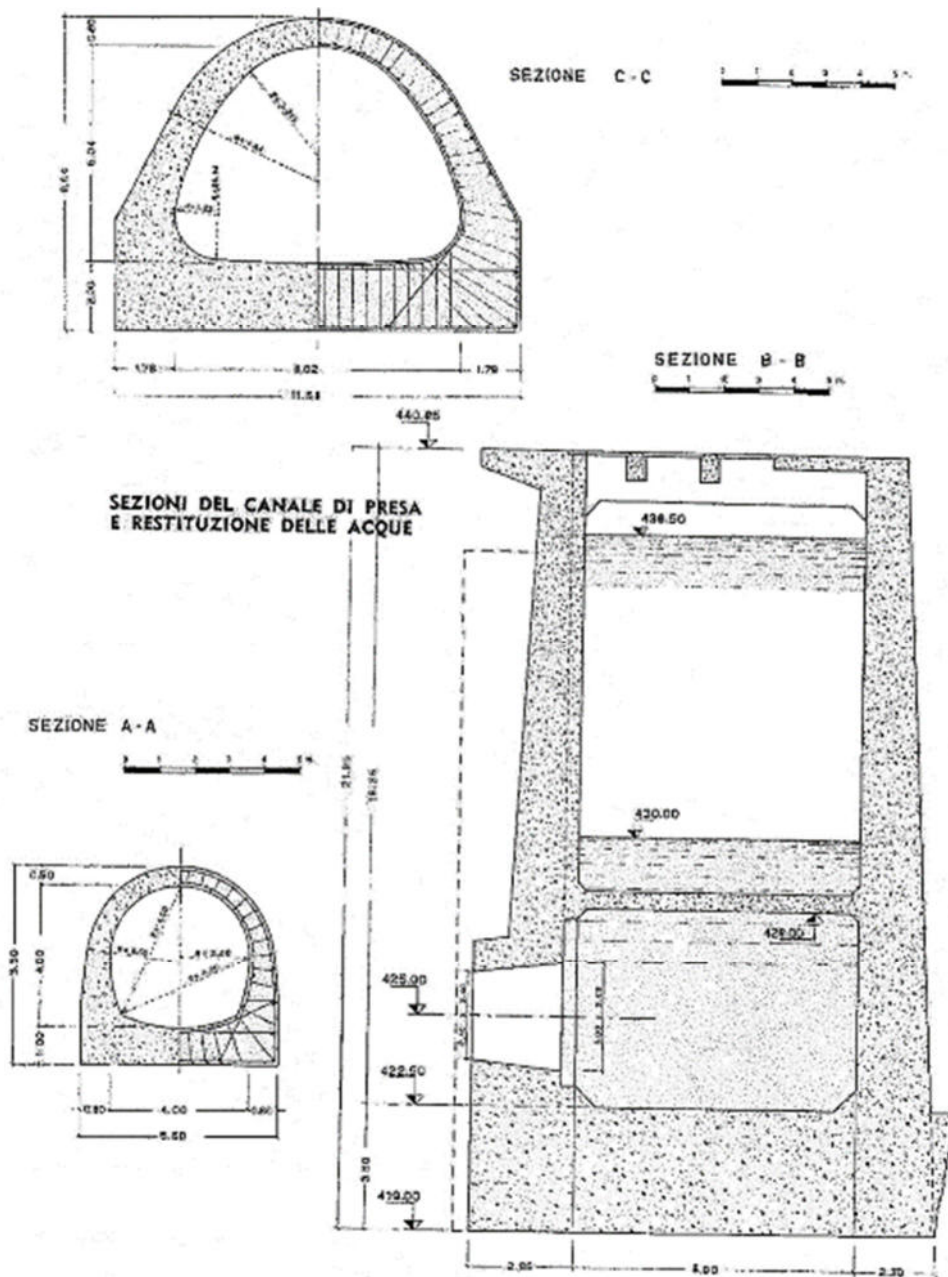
Sezione tipo del canale di presa e restituzione (ENEL, 2013)
